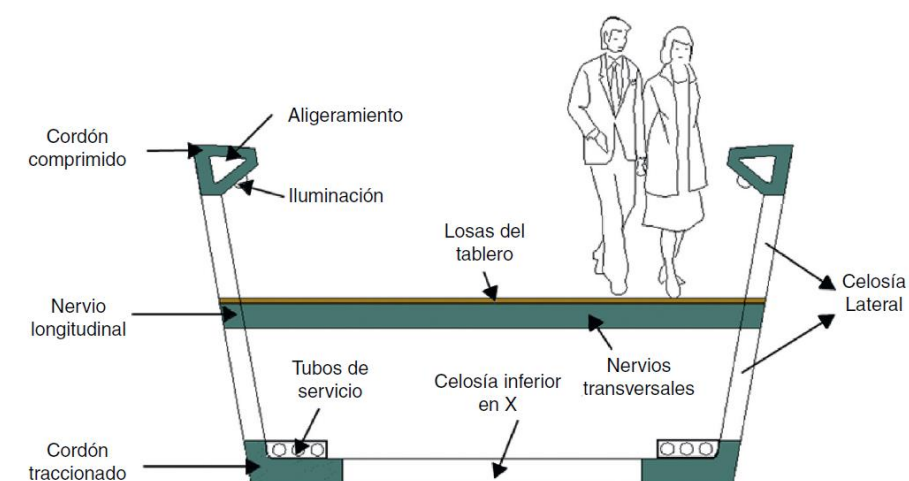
Sección transversal en centro-luz [Serna et al. 2015]
